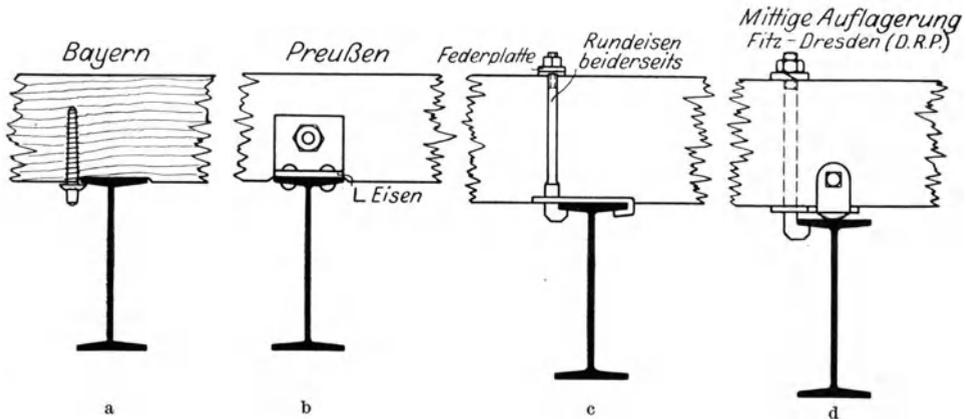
bis d. Schwellenbefestigung auf Eisenbrücken.
